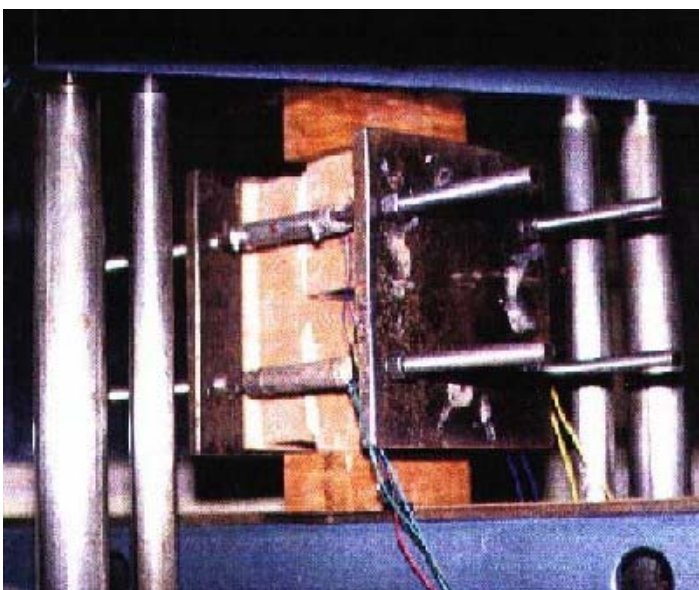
Dispositivo utilizado para aplicar precompresión
